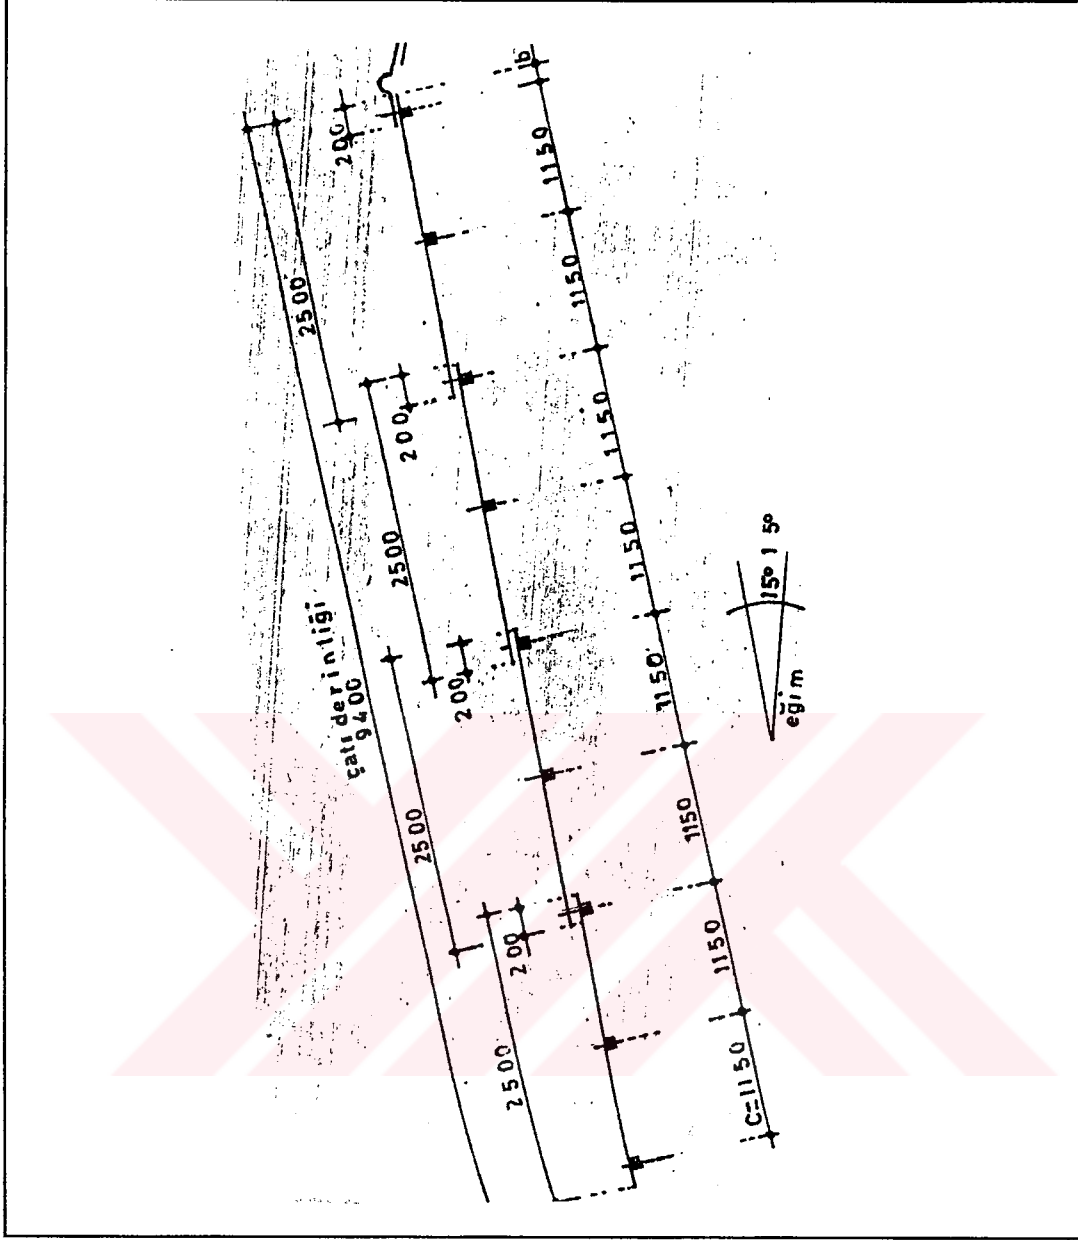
Asbest çimento oluklu levhaların aşıklara bağlanış şekli (Binan, 1990)
